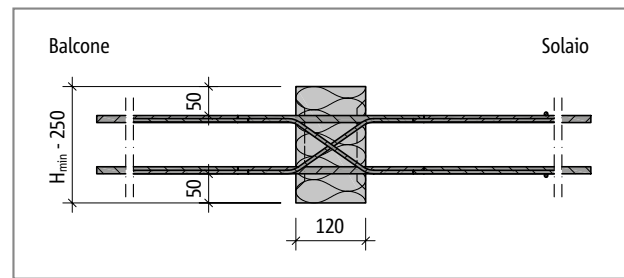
Schöck Isokorb® tipo DXT per CV50: sezione dell'elemento
